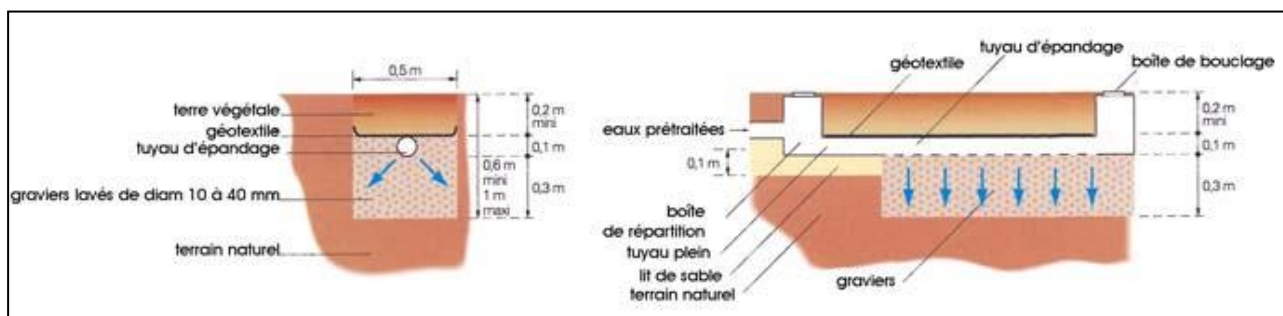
Schéma d'une tranchée d'infiltration (source : Landru.fr)
